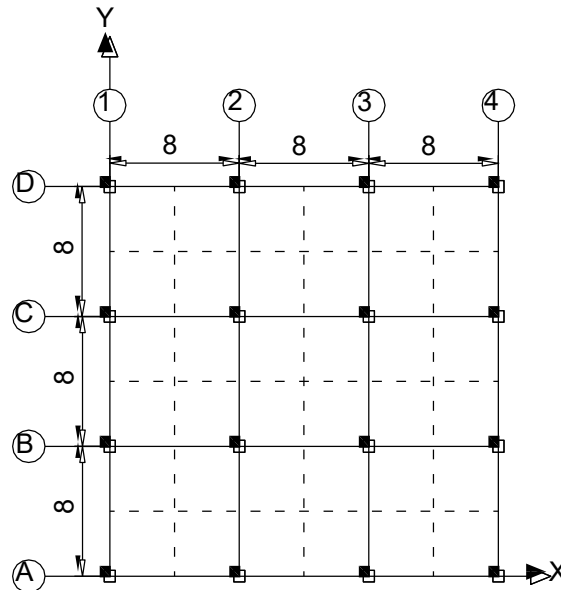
Planta tipo para las estructuras de 15 y 25 niveles. Cotas en metros.
